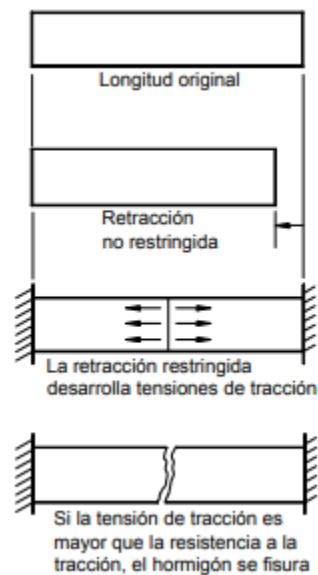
Fisuración del concreto provocada por la restricción por secado [21].
